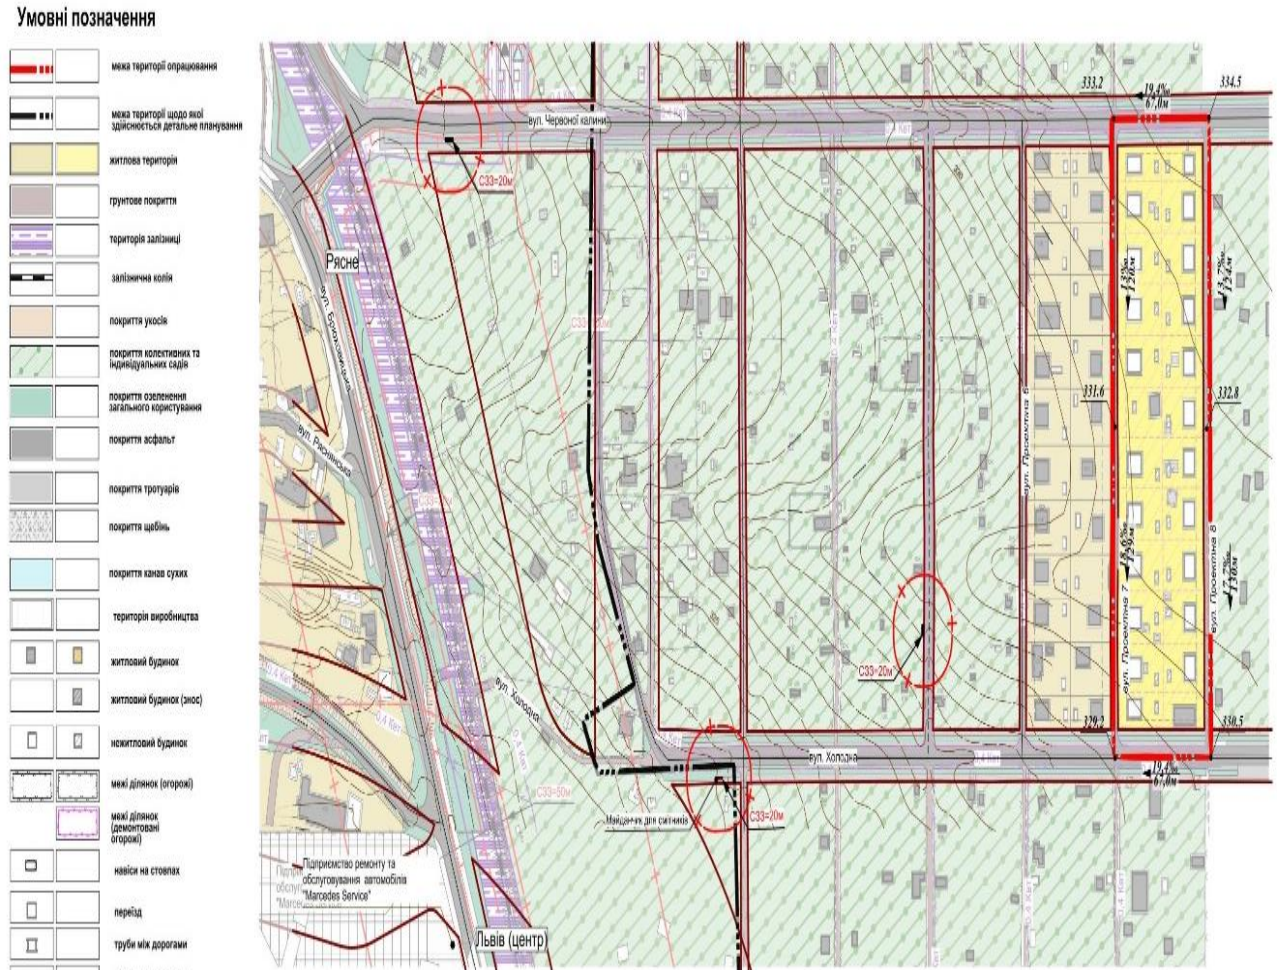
Схема вертикального планування для об'єкта дослідження, М 1 : 2 000.
